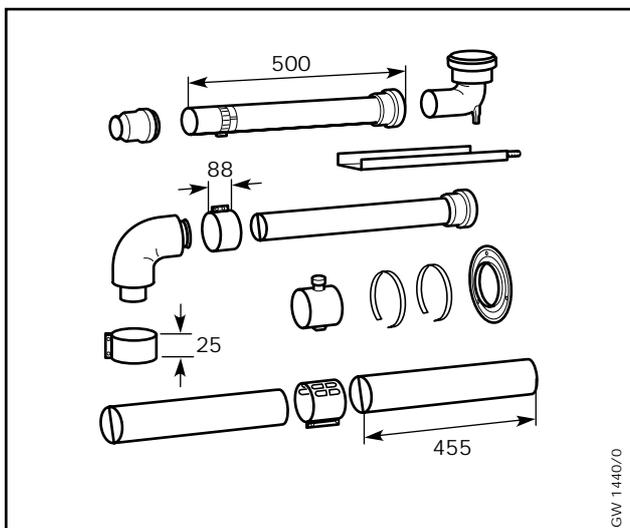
Schornsteinanschluß-Set für Abgasleitungen mit einem Durchmesser 80 (Verlegung im Schacht)
